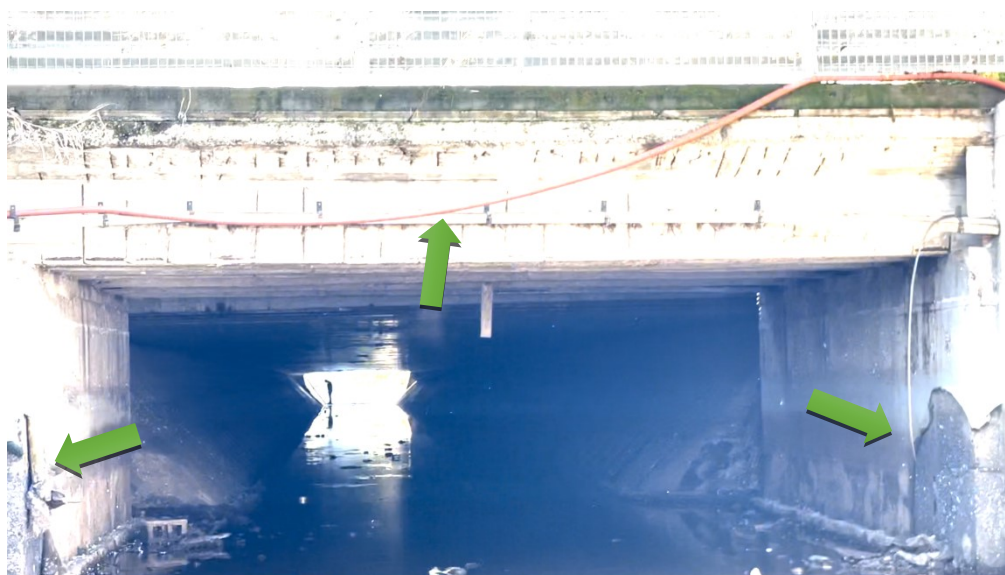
, lesioni telo pvc spalla dx ponte 3
